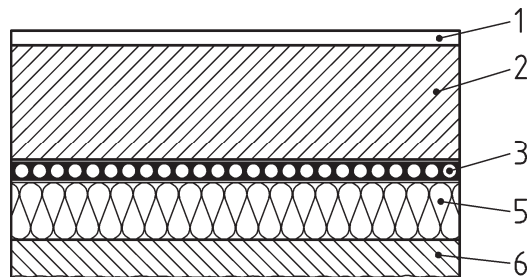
System mit Rohren unter dem Estrich Typs B
